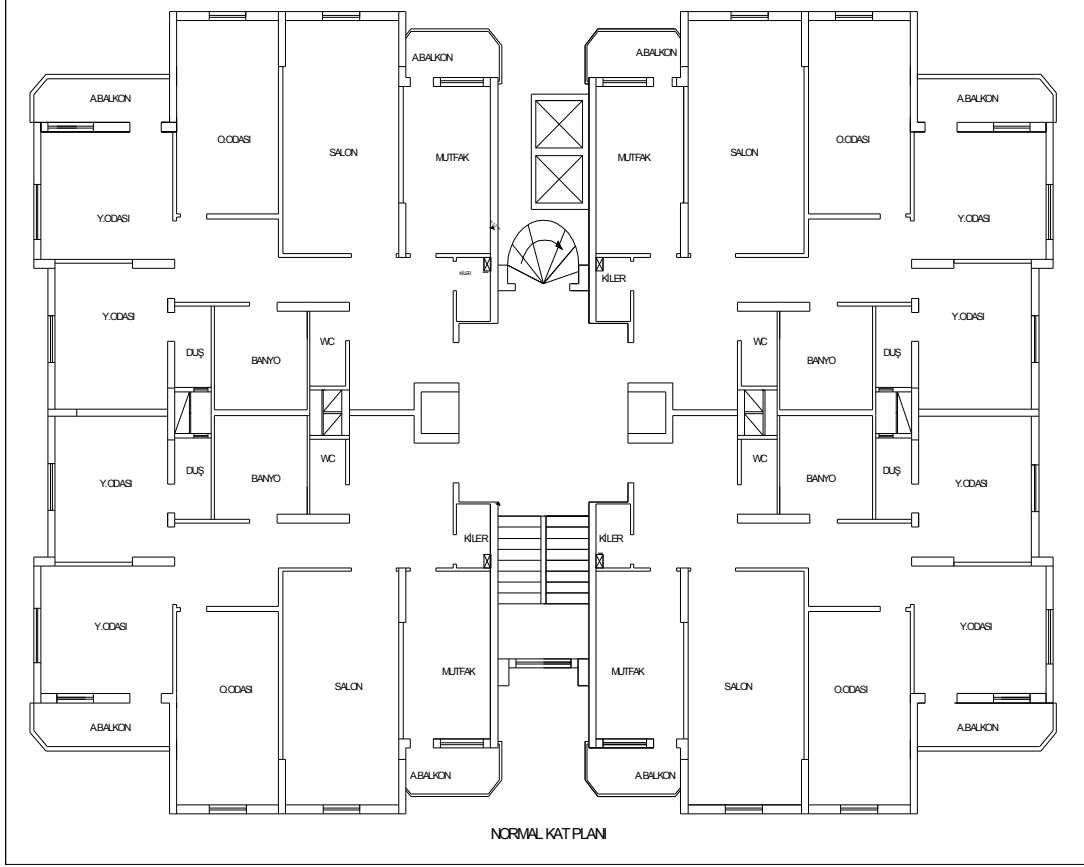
TIP-6 bina vaziyet planı (ölçeksiz)
